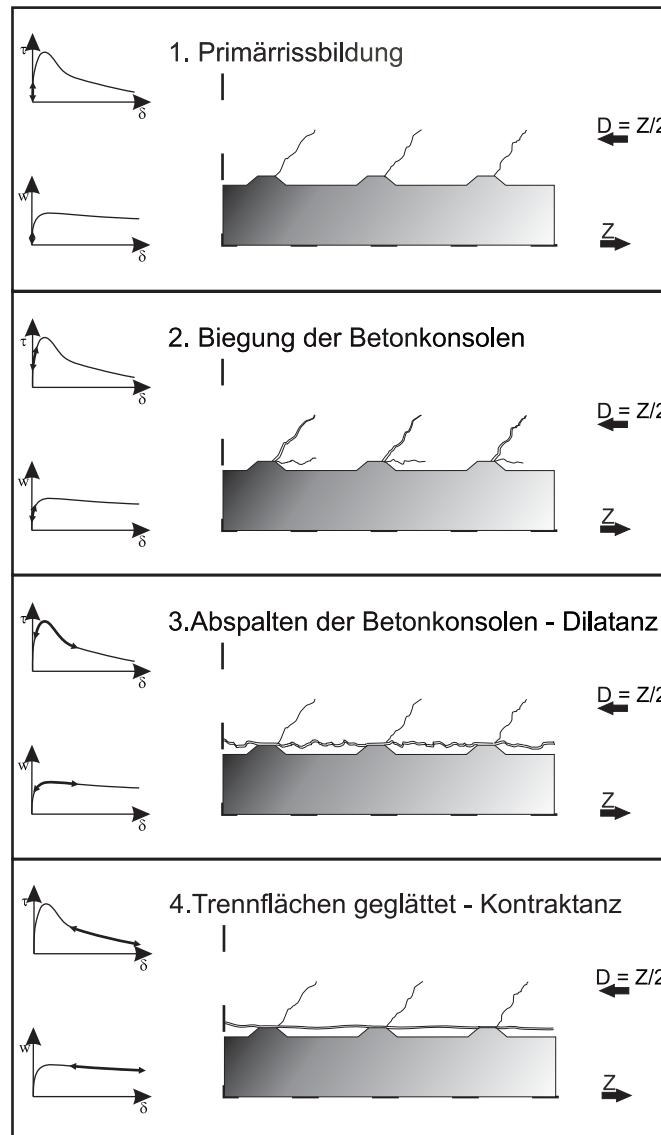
Örtliche Beanspruchung des Betons um den gerippten Bewehrungsstab nach [42]
